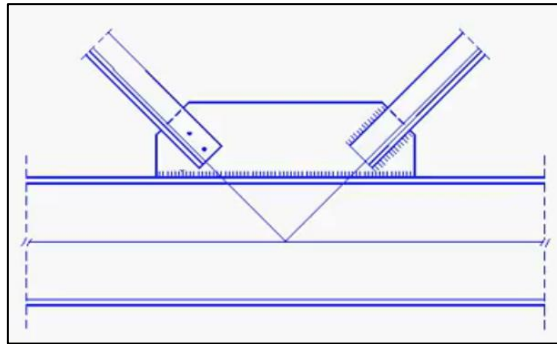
Unión de Celosía con tornillos y soldadura
